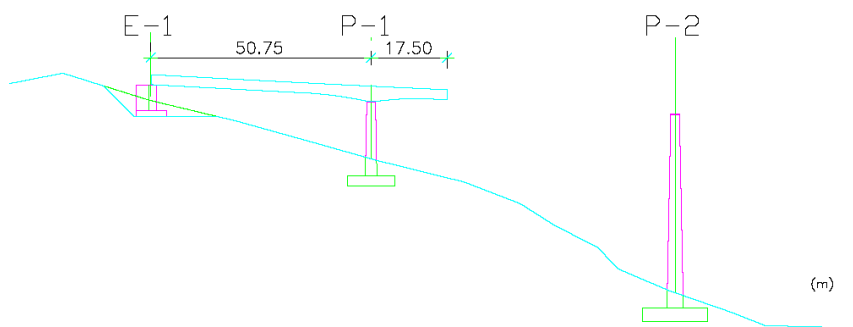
Construção do primeiro tramo do tabuleiro [28].
